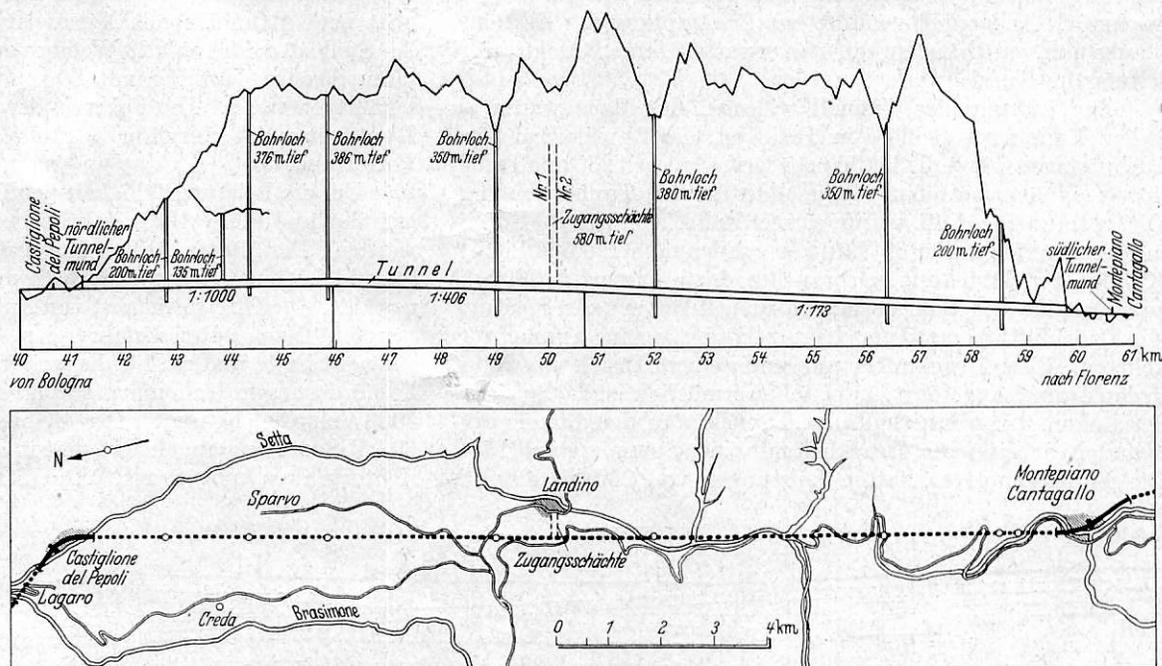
Längsprofil und Lageplan des neuen Apennin-Tunnels.
